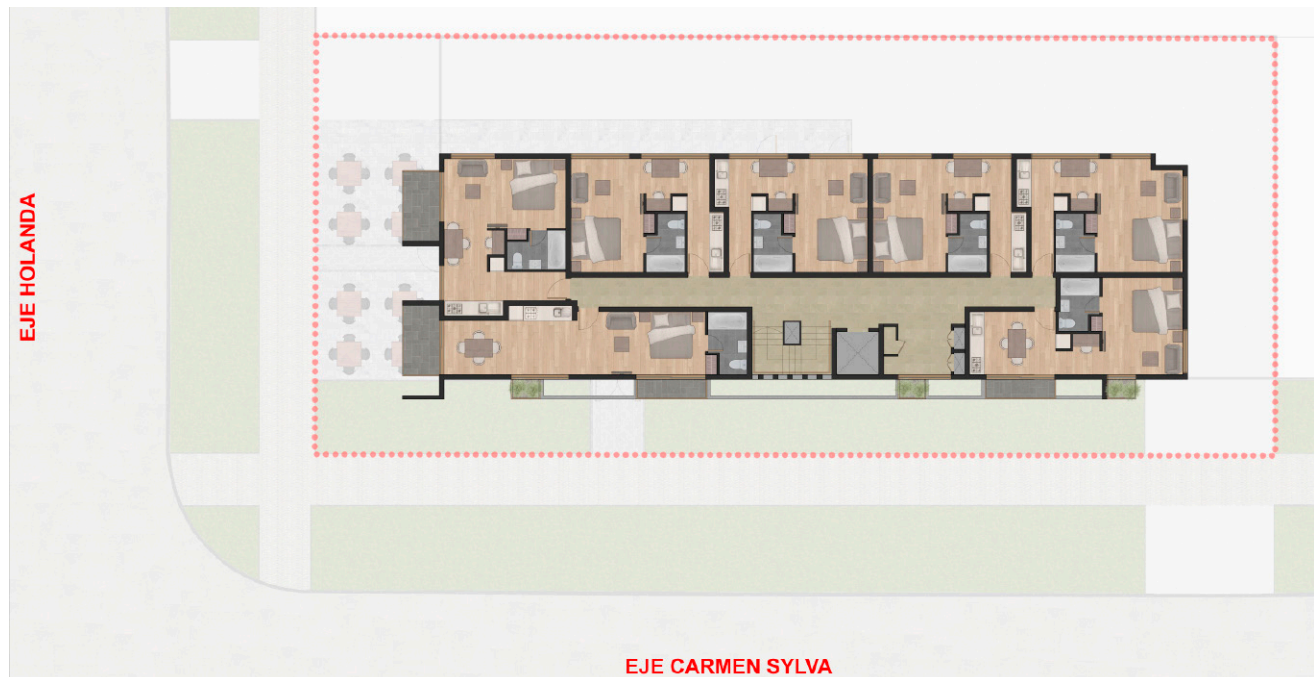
Planta de arquitectura piso tipo 6 y 7. Escala 1:1000. Fuente: El autor (2019).
